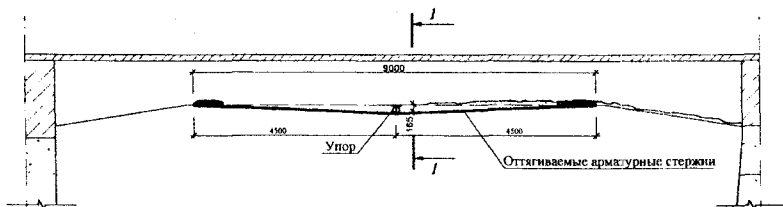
Схема усиления балки пролетного строения локальным обжатием внешней дополнительной арматурой
